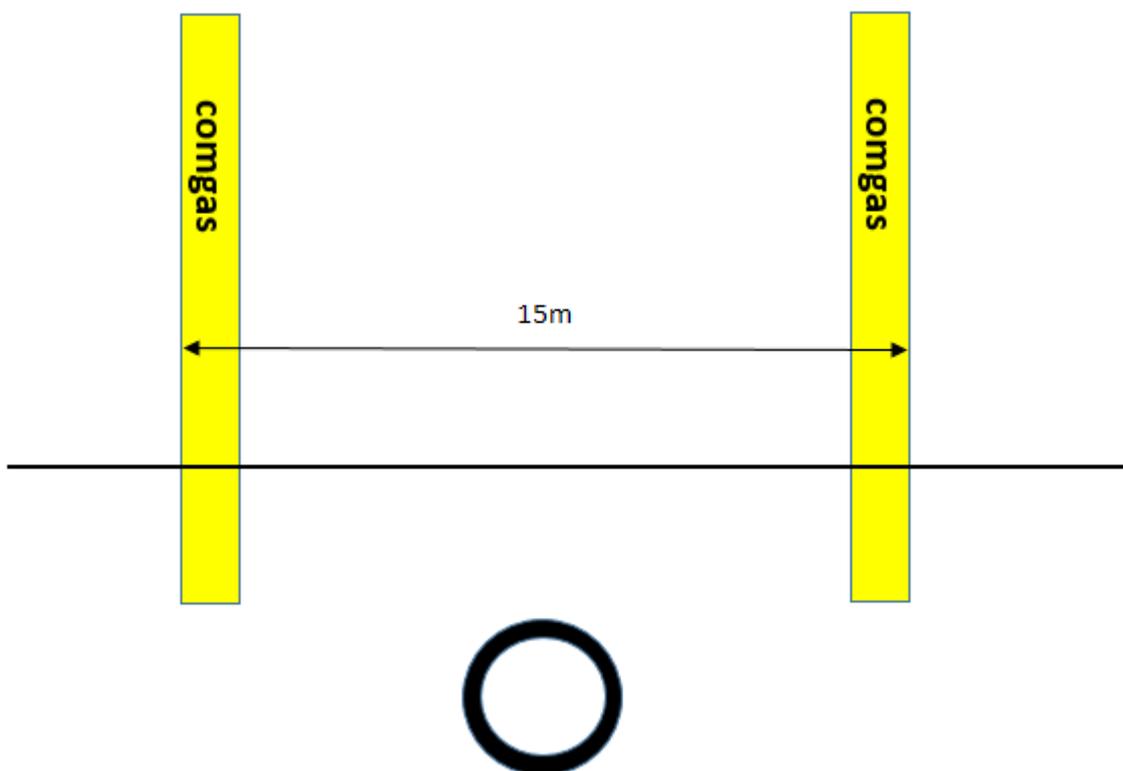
Arranjo típico da implantação do gasoduto terrestre e faixa de servidão na fase de implantação.
